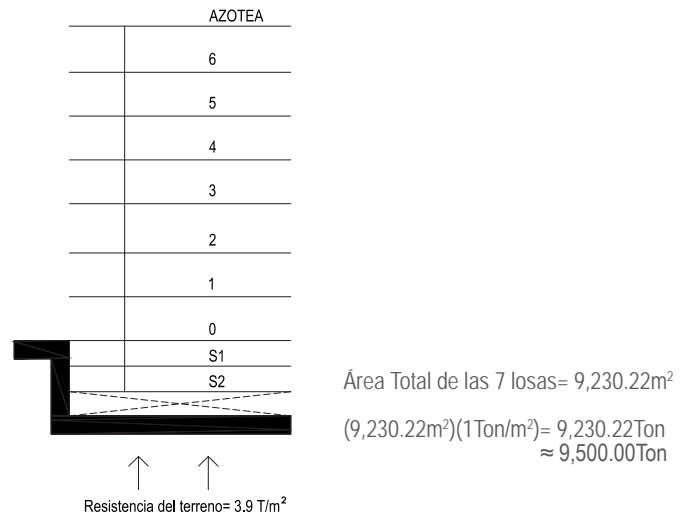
| Losas de entrapiso para cálculo de cimentación
